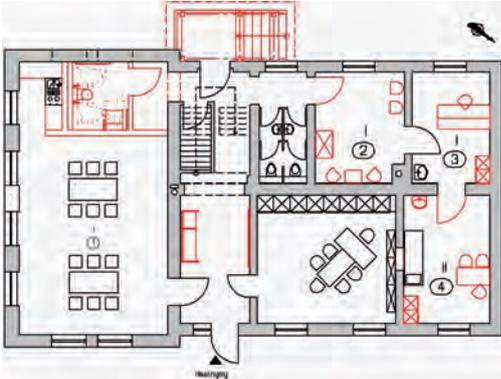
Grundriss „Alte Schule m.H.“
